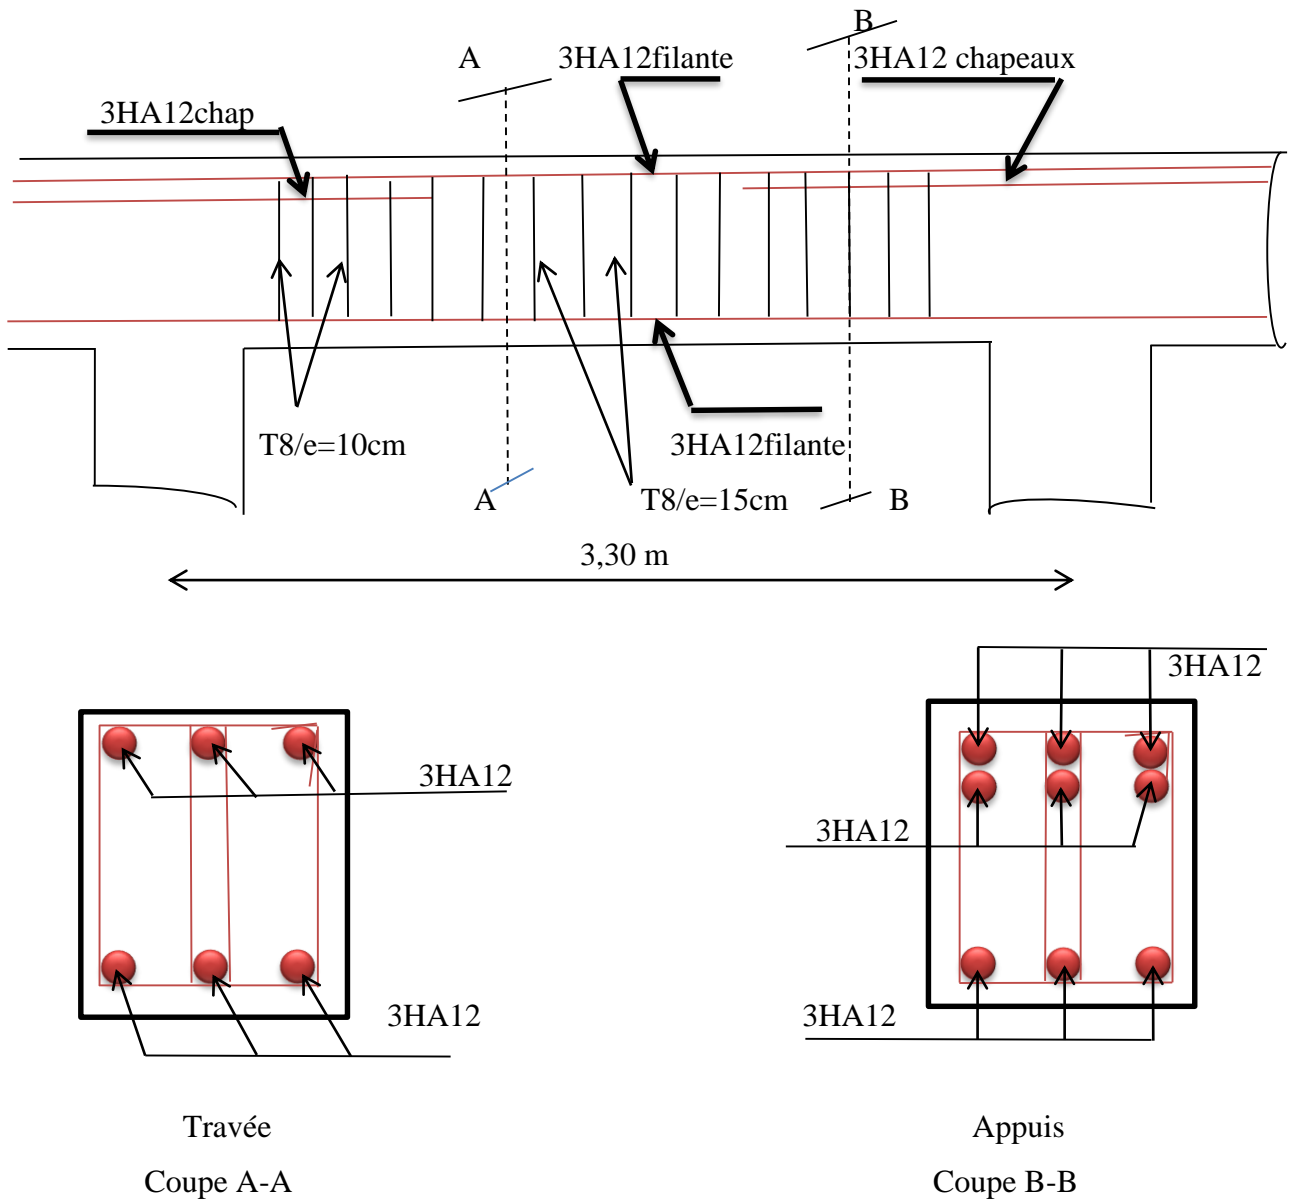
Schéma Ferrailage des poutres secondaire
